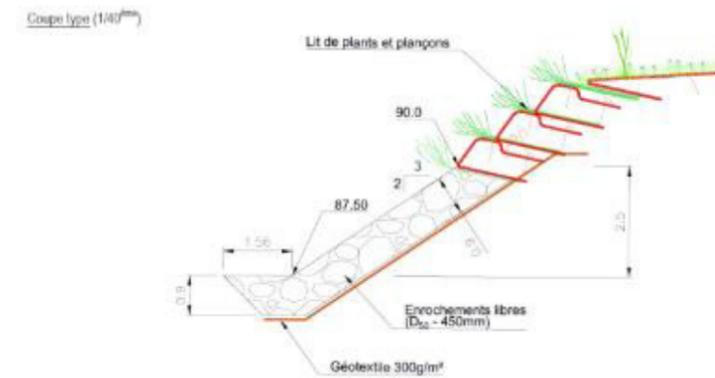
coupe de la protection en rive droite (source : Étude de confortement des berges, Artelia – octobre 2024)
